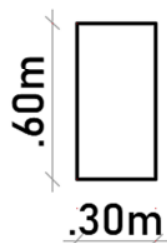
Levantamiento de columnas de concreto TP2 y TP3
